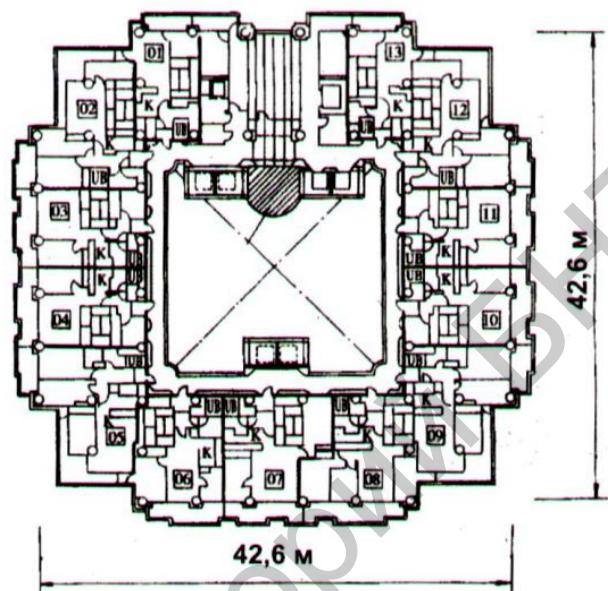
План высотного жилого высотного здания с трубобетонными колоннами в г. Кавачуги, Япония
